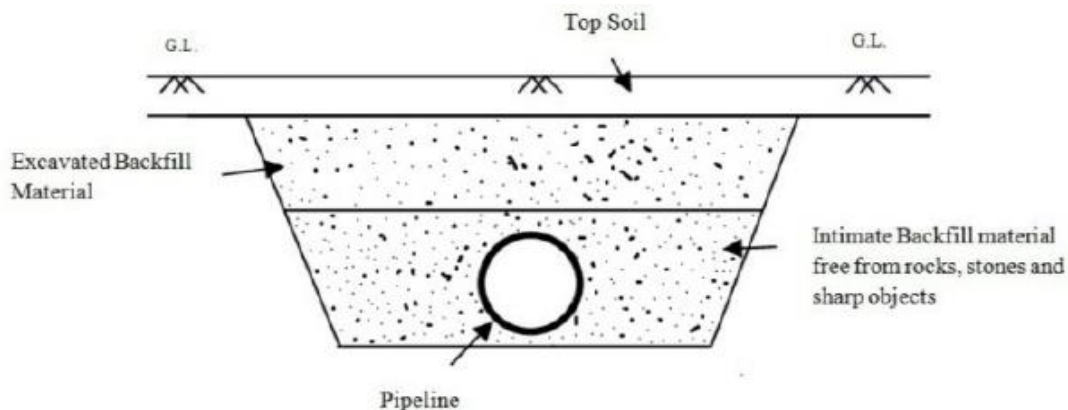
Схематичний поперечний переріз траншеї ВОЛЗ у багатошаровому ґрунті
